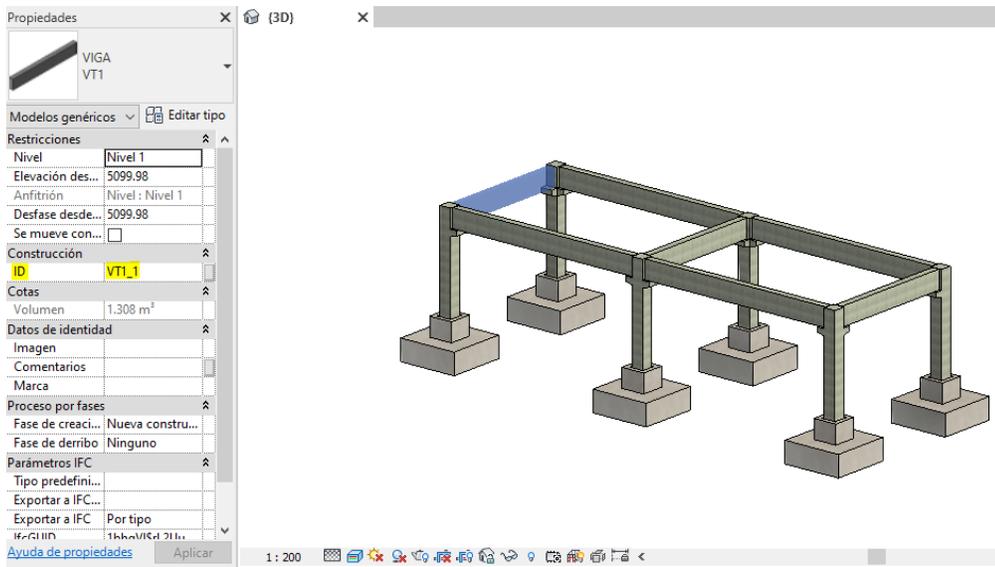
Primera asignación de “ID” a viga tipo 1. Fuente: Elaboración propia.
